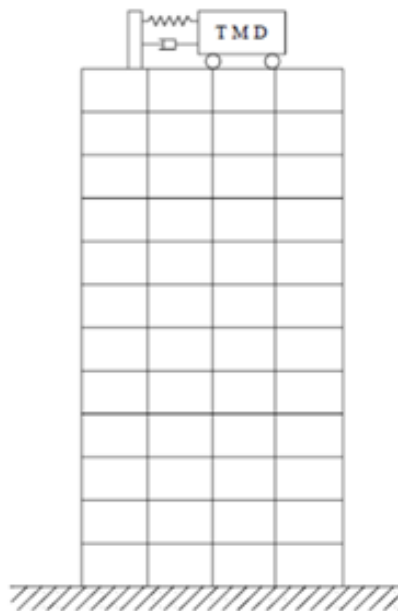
Amortiguador de masa (TMD) instalado en la planta superior de un edificio.
